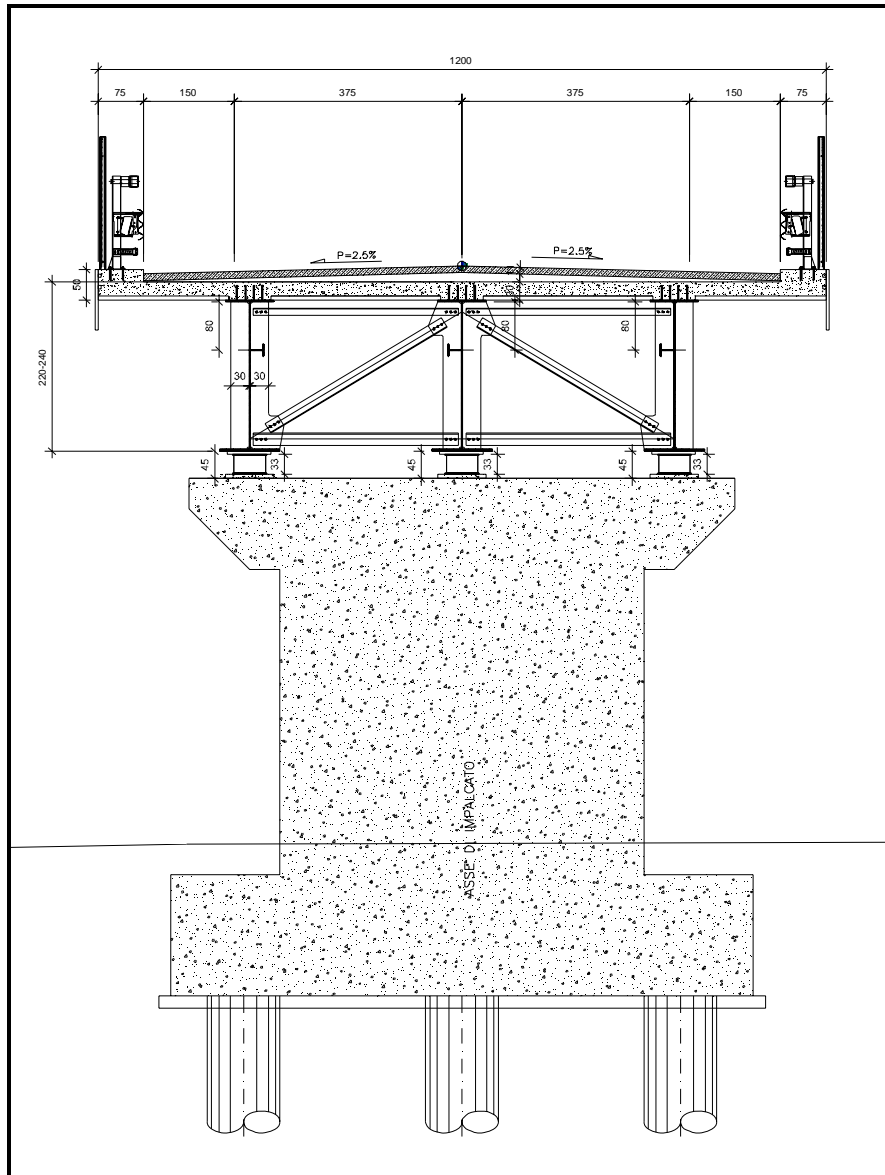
Cavalcavia progressiva 95+200 – Sezione trasversale
